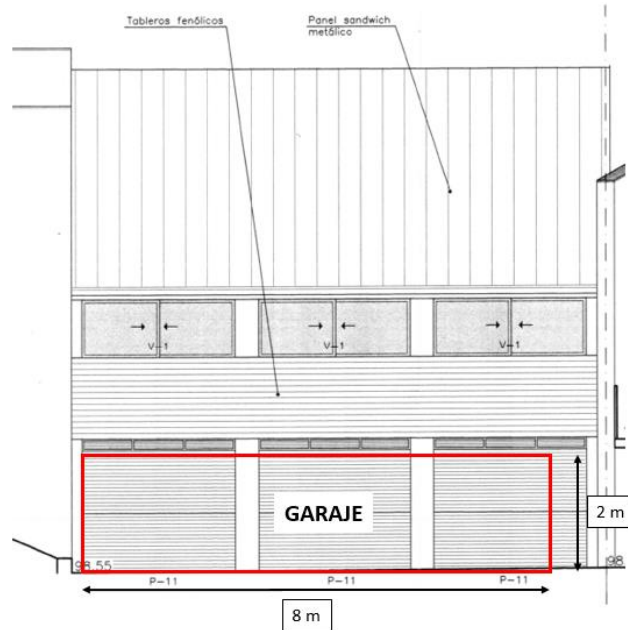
Vista de alzado (norte) de la ubicación de la habitación<sup>21</sup>.
